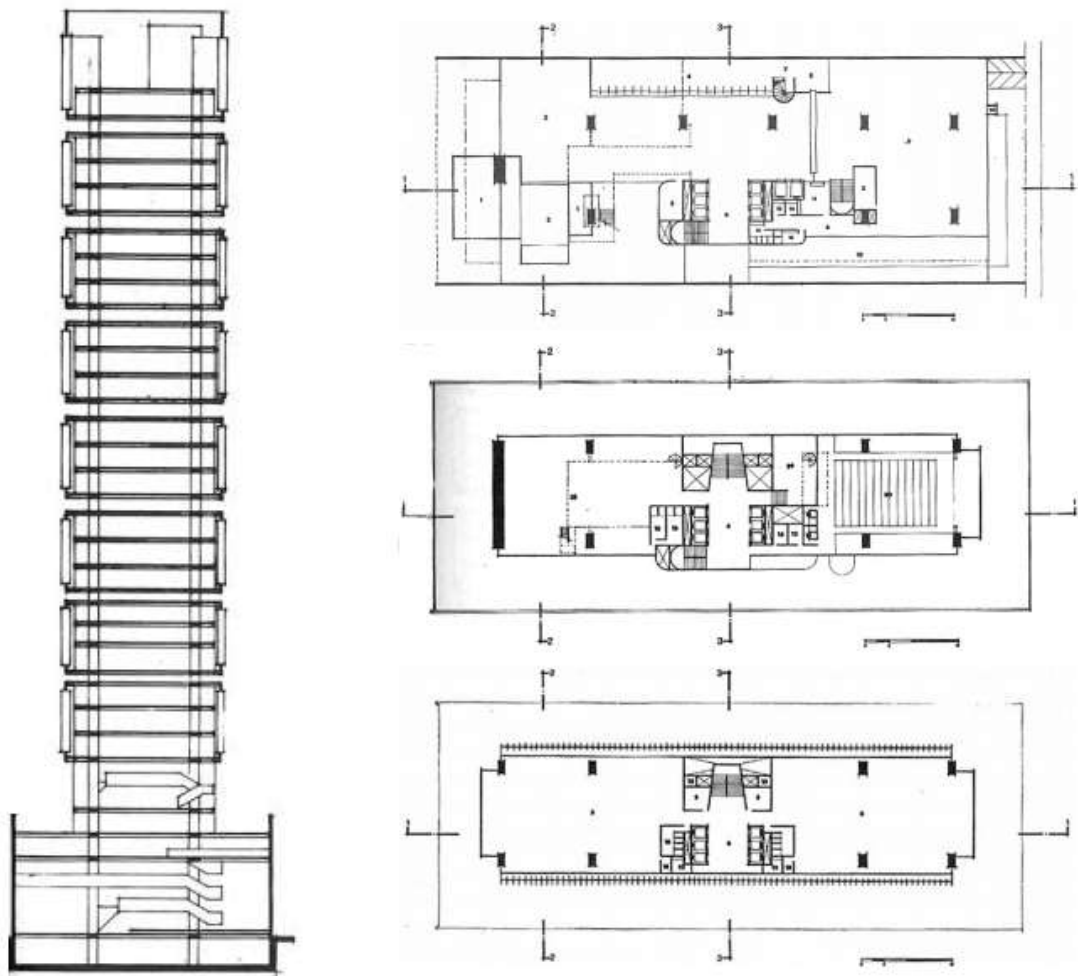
Corte transversal do projeto original e plantas do térreo, auditorio/biblioteca e pavimento tipo
